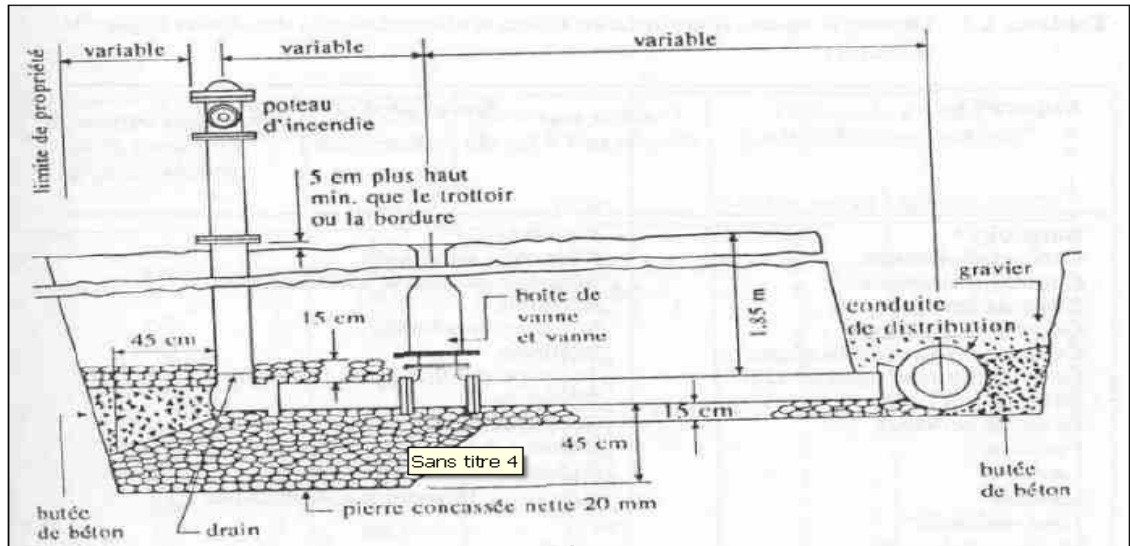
Installation d'un poteau d'incendie vue en coupe
